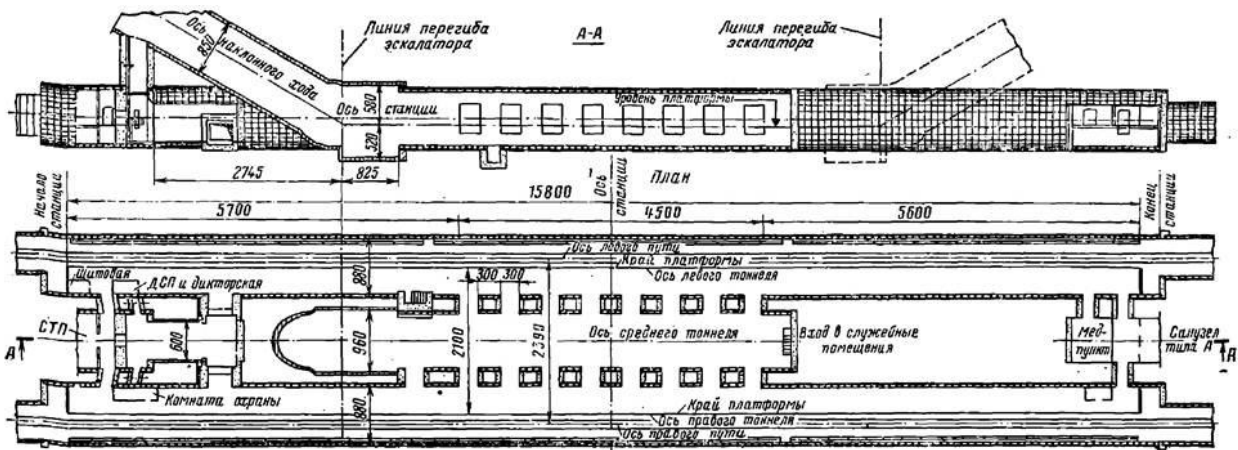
План и продольный разрез трехсводчатой станции пилонного типа
